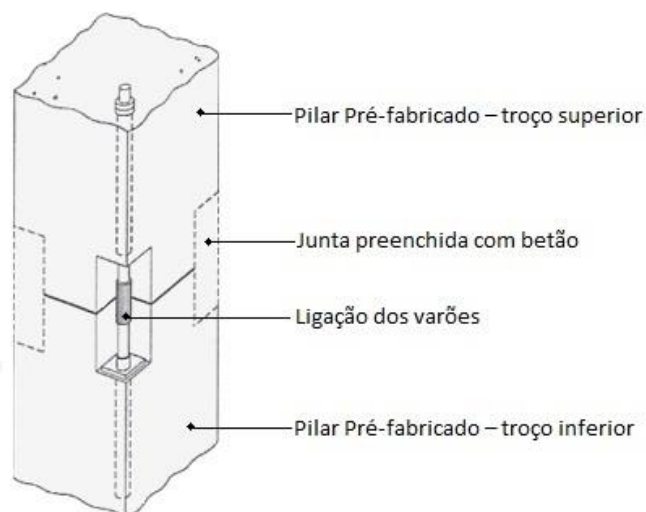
Ligação Pilar – Pilar por pós-tensão [46]
